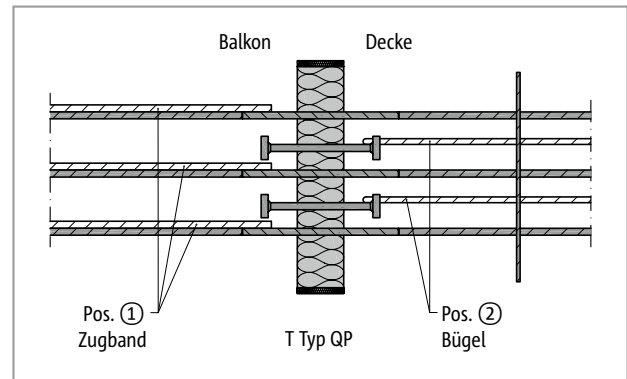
Schöck Isokorb® T Typ Q-P: Detail 1; Bewehrungsanschluss Zugband
